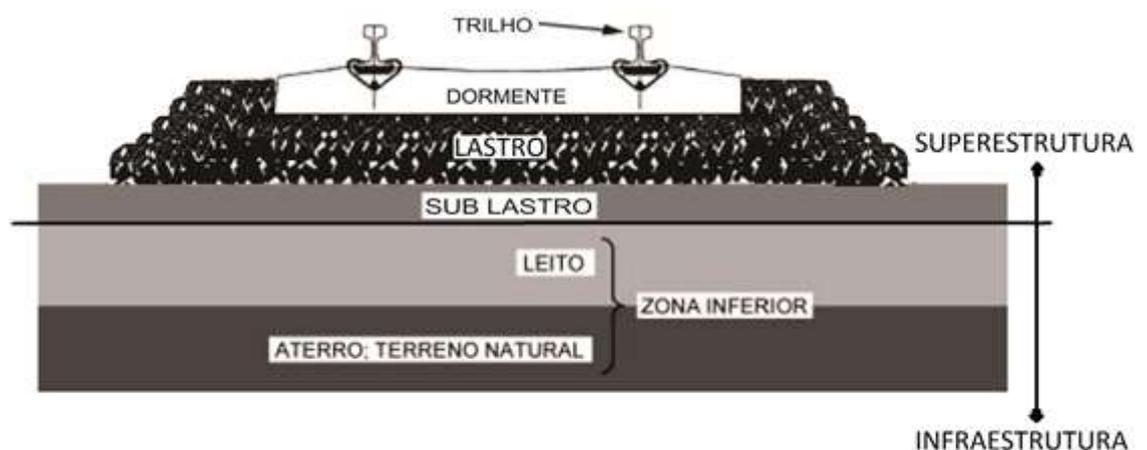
Componentes da Infraestrutura e Superestrutura
